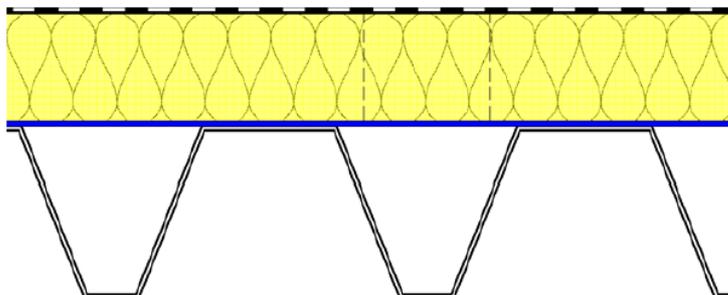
Bestandsaufbau, Trapezblech-Tragkonstruktion, darüber bituminöse Bauzeitabdichtung (blau), 100 mm Mineralwolle und bituminöse Dachabdichtung.
